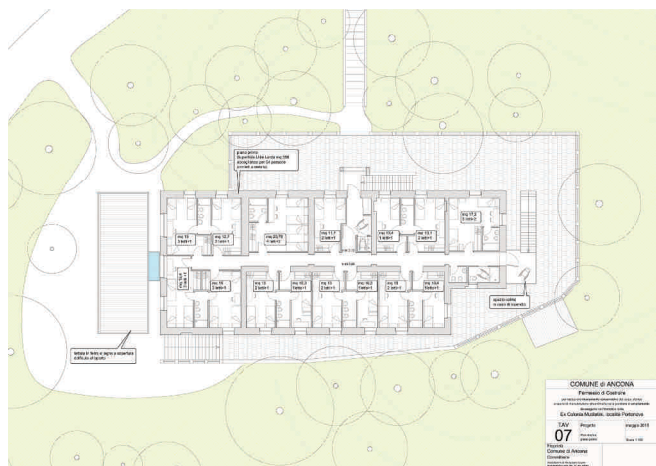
Planimetria piano primo - Ostello con 55 posti letto
